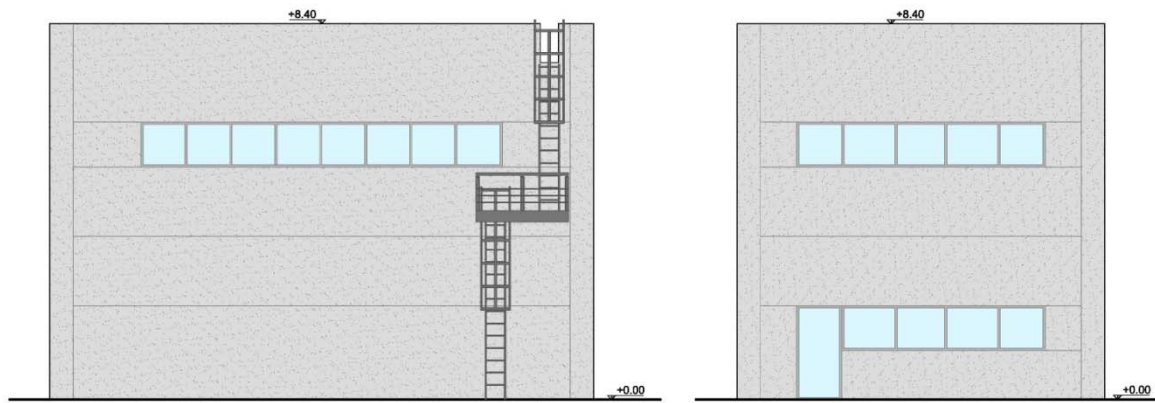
Prospetti palazzina – a sinistra prospetto nord, a destra prospetto est
